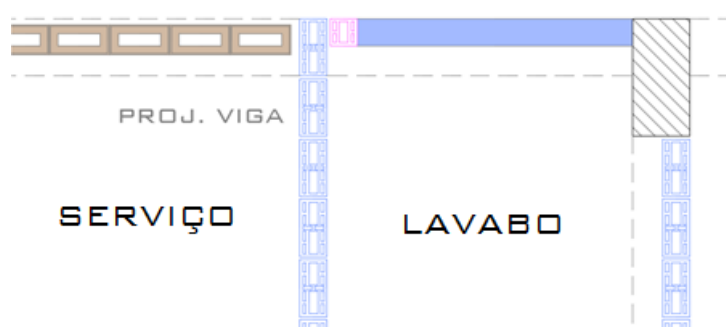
Planta baixa marcação de alvenaria (ver completa na Prancha 08 no fim deste trabalho).
